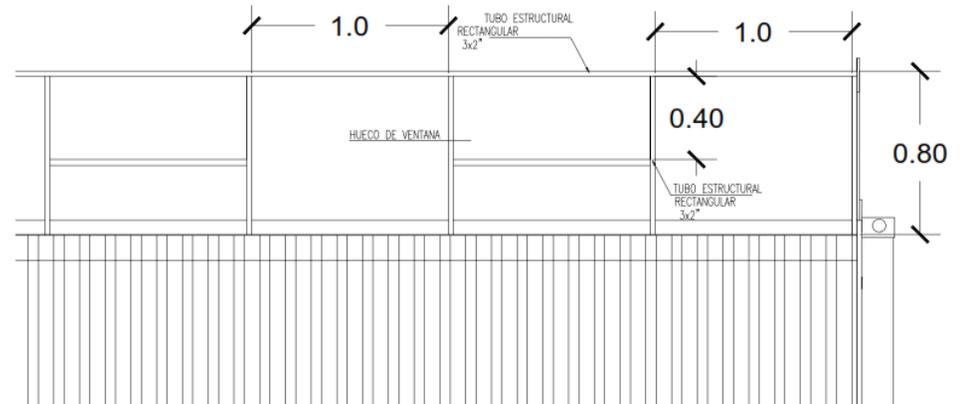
Detalle de fijación de Tubo Estructural al Poste Esquinero
